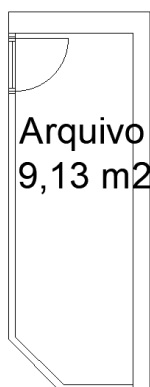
Planta em 2D do arquivo da AE ISEC.
